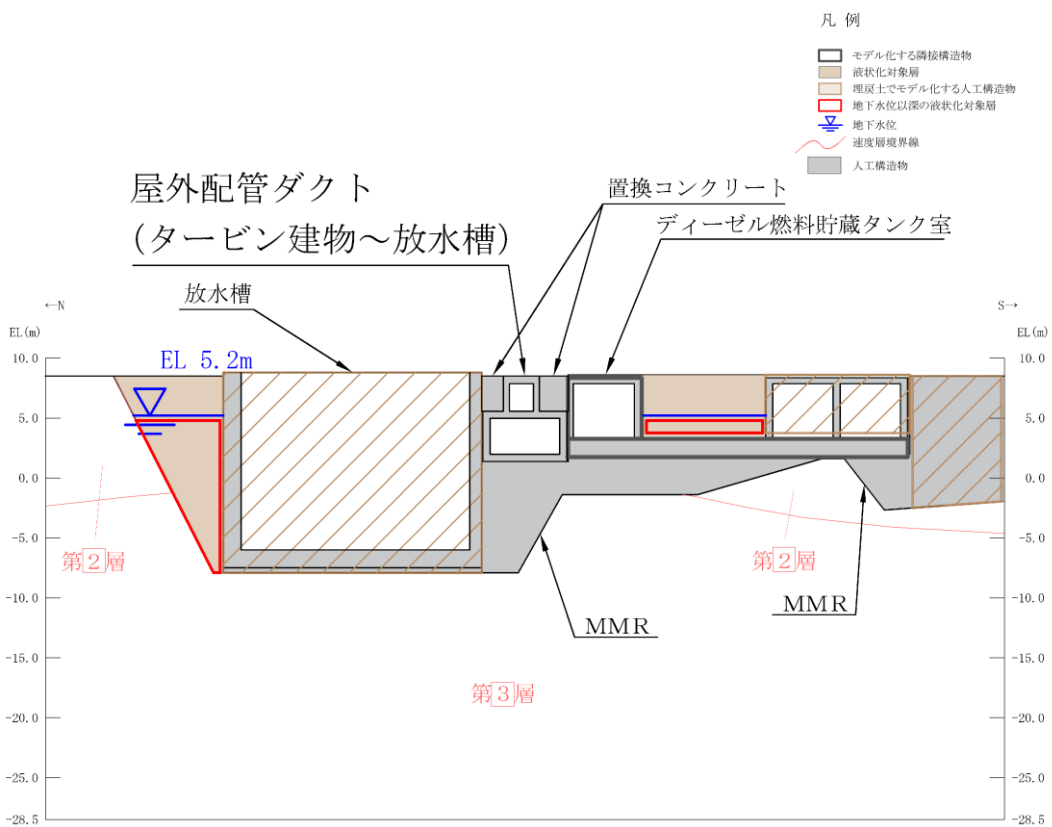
屋外配管ダクト (タービン建物～放水槽) 評価対象断面図 (B-B 断面)
